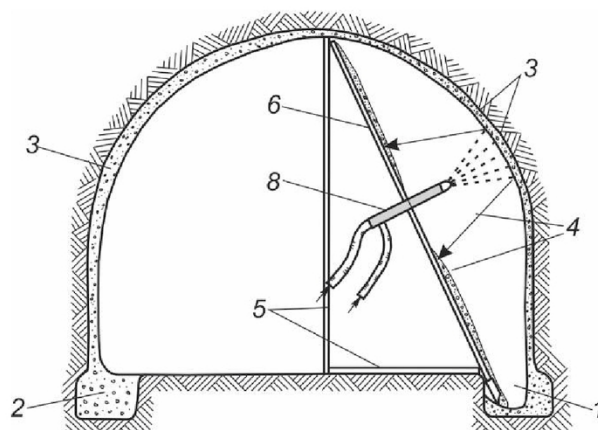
Нанесение набрызг-бетона на поверхность горной выработки с улавливанием отскока: 1 – приямок; 2 – фундамент крепи; 3 – участок набрызг-бетонной крепи; 4 – отскок бетонной смеси; 5 – опорная рама щита; 6 – щит для улавливания отскока; 8 – сопло;  $\alpha$  – угол наклона щита;  $\beta$  – угол наклона бока выработки
